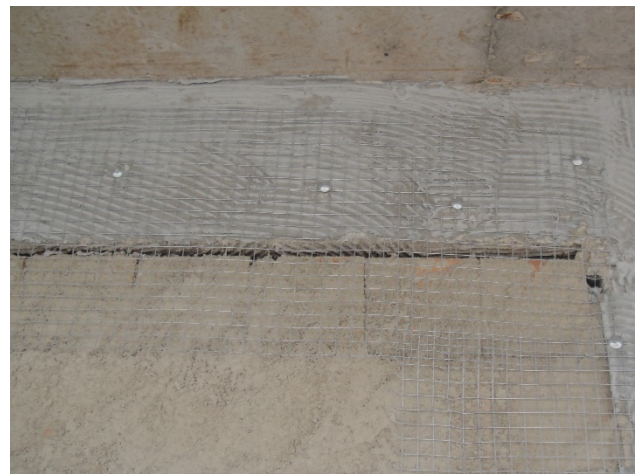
Fixação superior da alvenaria com mau preenchimento
